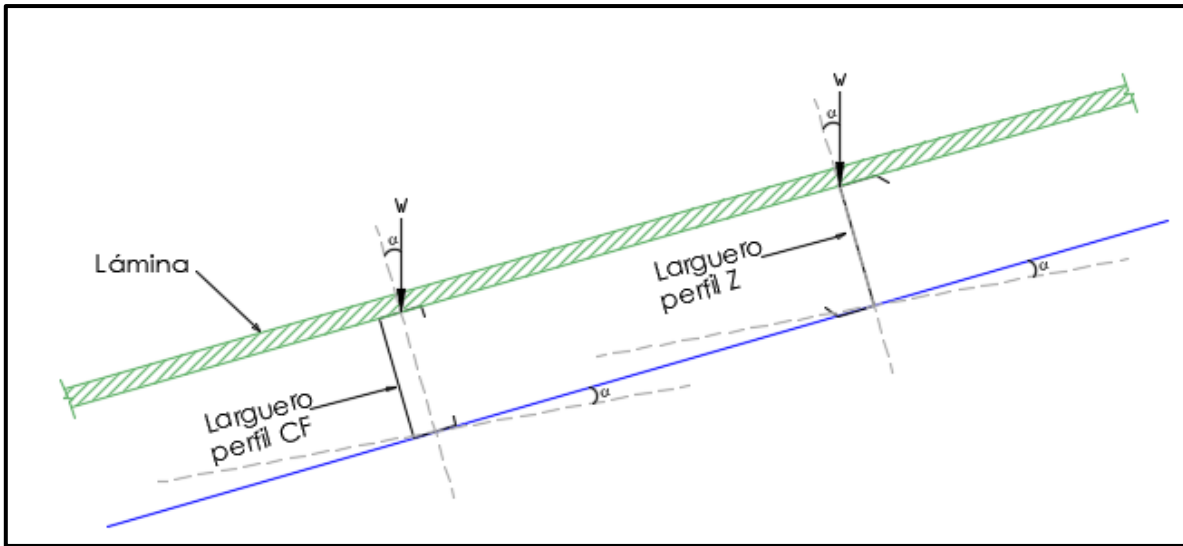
Largueros de perfil CF y Z colocados según ángulo de inclinación de pórticos principales de la cubierta (autoría propia, 2021).
